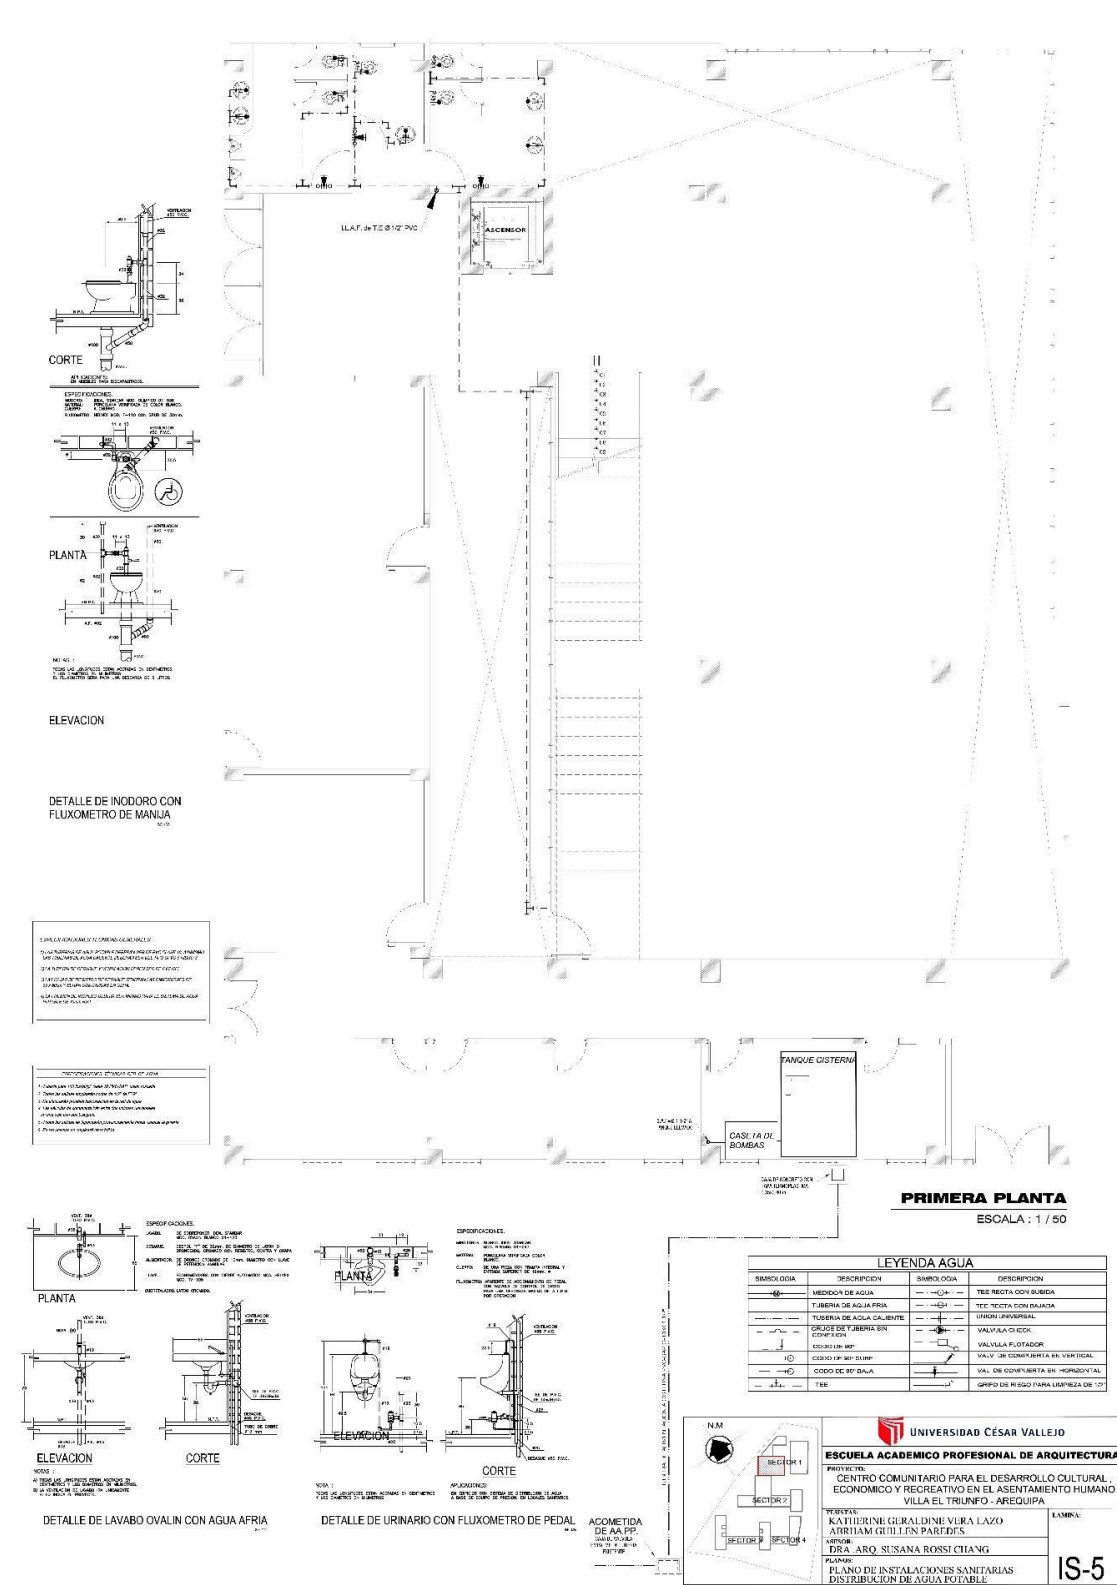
Planos de distribución de redes de agua potable Primera Planta - Elaboración propia
